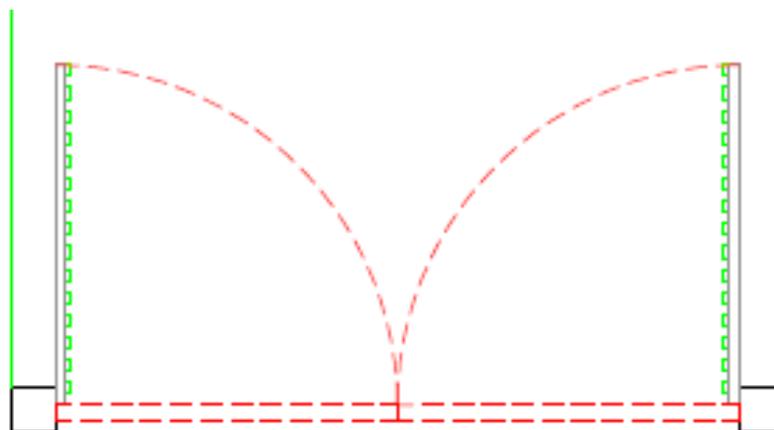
Vista en planta de la puerta batiente a doble hoja de garaje, en posición abierto hacia el interior de la vivienda.
